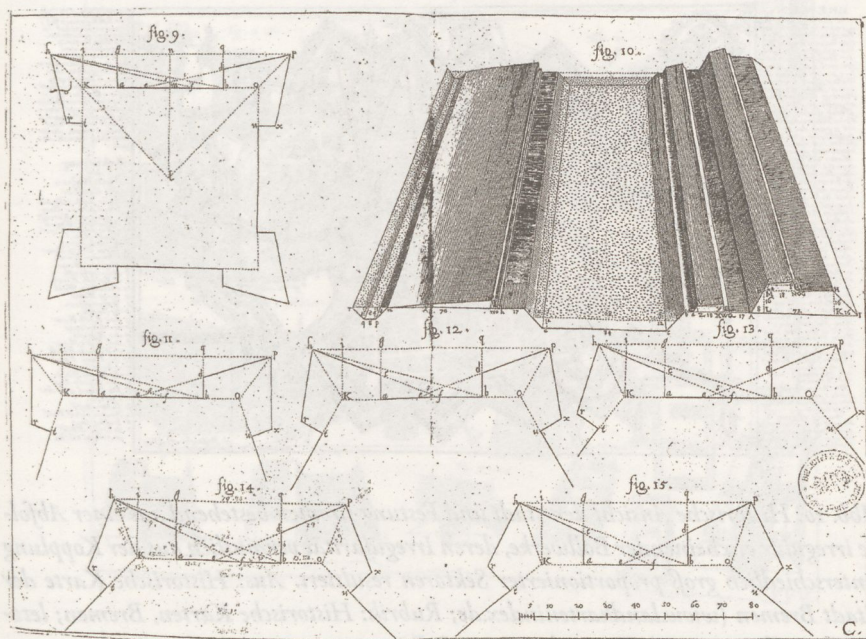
Grundrissentwürfe für die Hauptwälle zwischen zwei Bollwerken vom Viereck bis Neuneck; oben recht: Profilschnitt mit einem gedeckten Weg links vom Graben und einem Hauptwall mit vorgelagertem Unterwall rechts vom Graben. Aus: Freitag, Adam: *Architectura Militaris – Nova et aucta oder Neue vermehrte Fortification Von Regular Vestungen, Von Irregular Vestungen vnd Aussen wercken*. Ausgabe: Amsterdam 1665, Taf. C.
